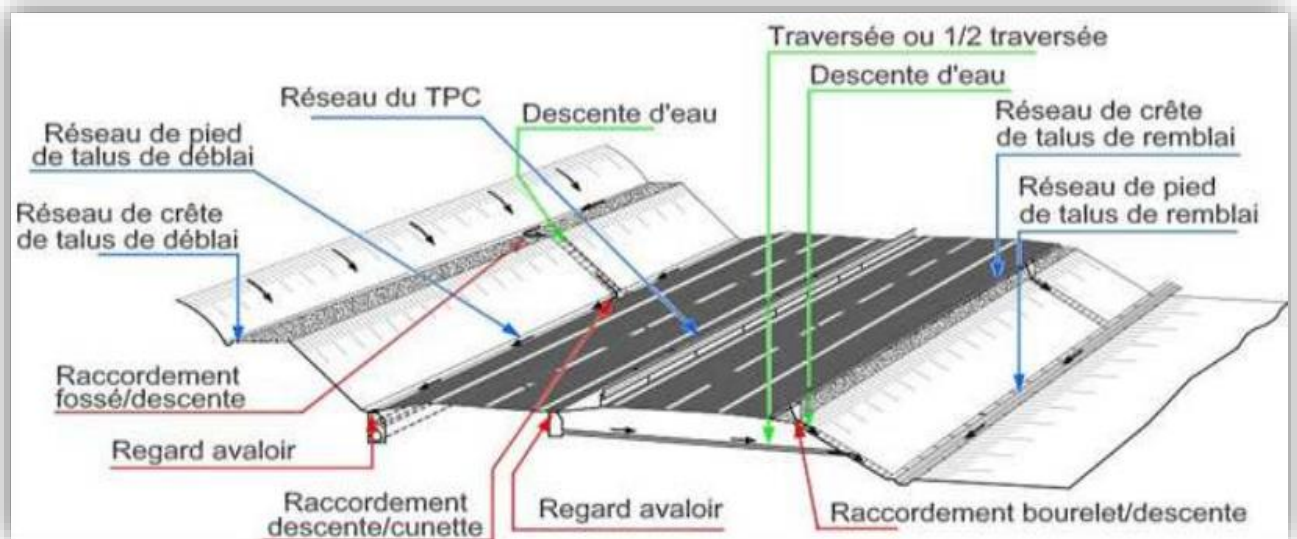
Principaux types d'ouvrages d'assainissements.
